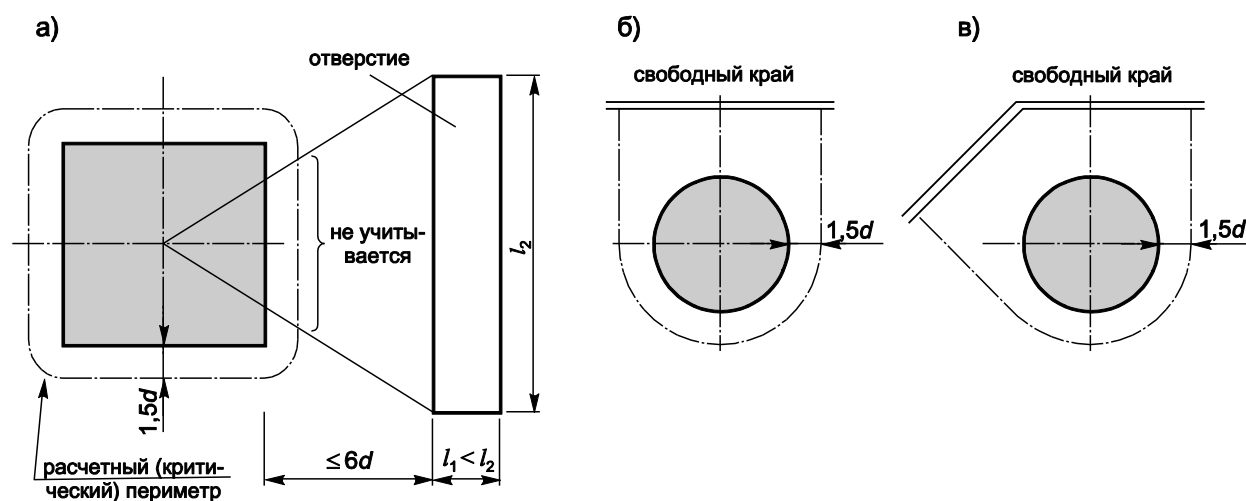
Критический периметр для площадей приложения местной нагрузки, удаленных от свободных краев плиты и отверстий
